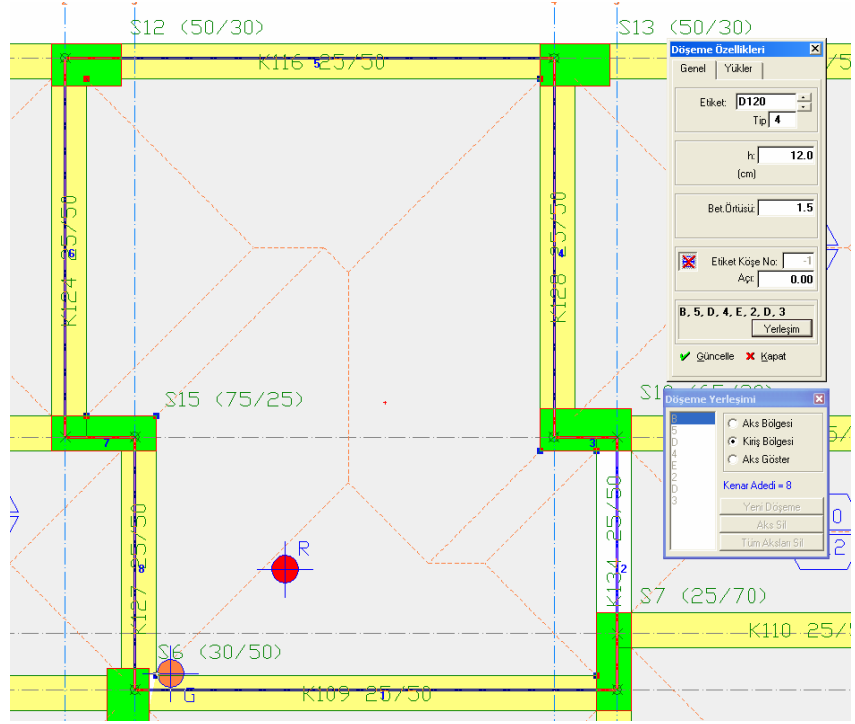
Alternatif Yöntem – Herhangi bir uçtan tanımlanmış kolon
